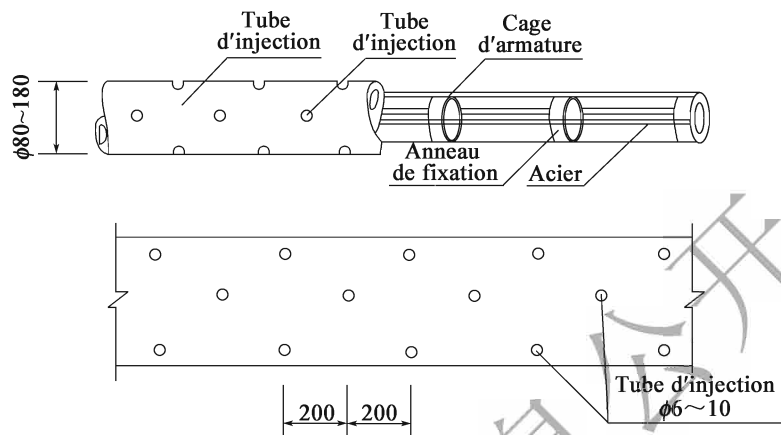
Structure du tube d'acier pour la voûte parapluie (unité : mm)
